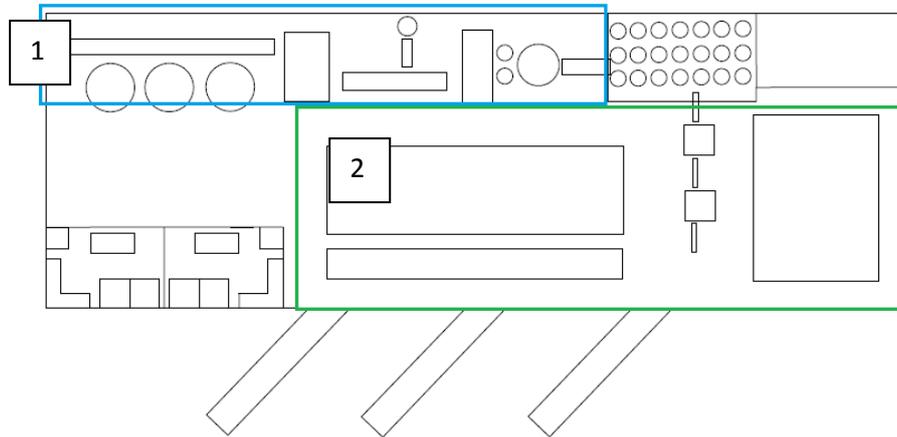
Zonas de la planta a estudiar para las propuestas de iluminación.
